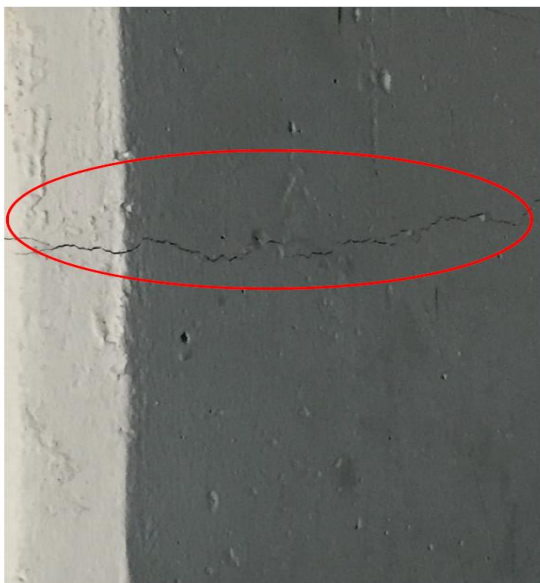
FIGURA COLUMNA C-7 VER ANEXOS DOCUMENTO LOCALIZACION COLUMNAS
